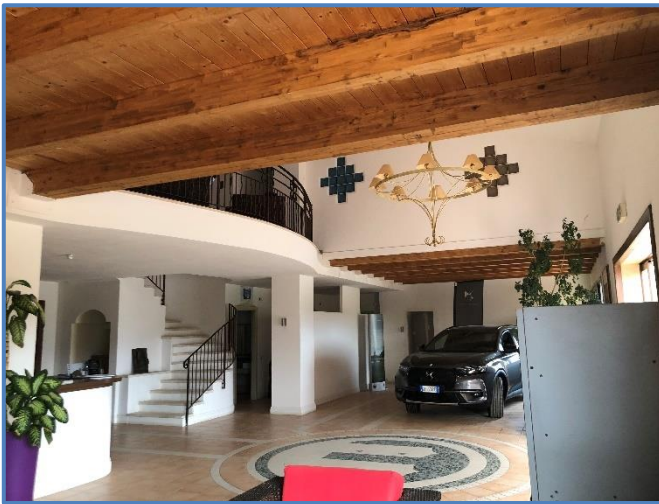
52 - vista dell'intradosso del solaio realizzato per l'ampliamento del soppalco
